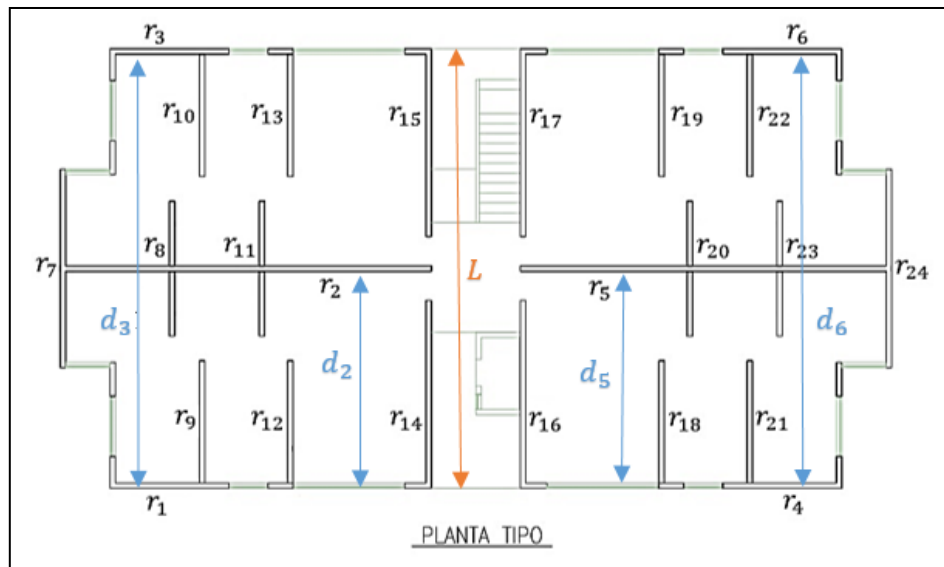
Ejemplo de vista en planta con distancias hasta el extremo del piso
